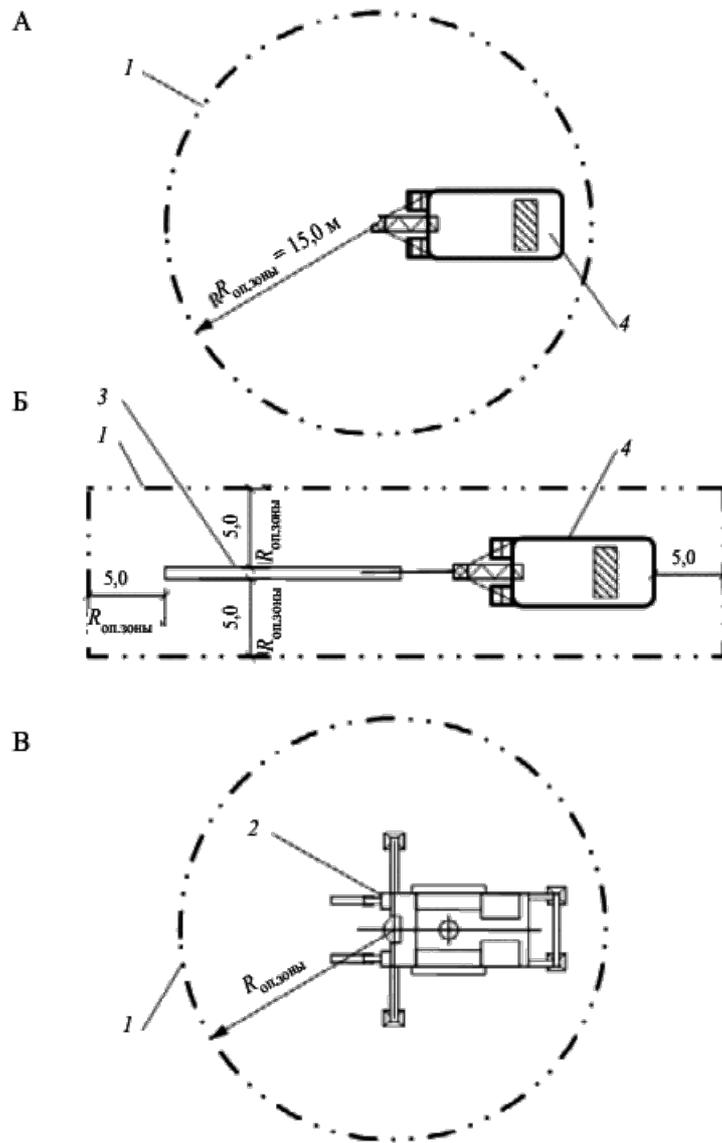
Расчётная схема определения опасных зон при устройстве свай:
